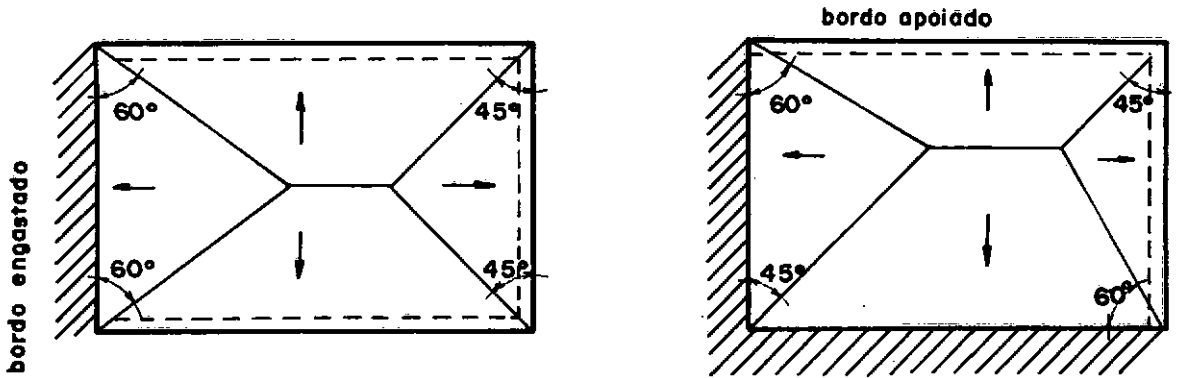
Distribuição do carregamento das lajes sobre as vigas
